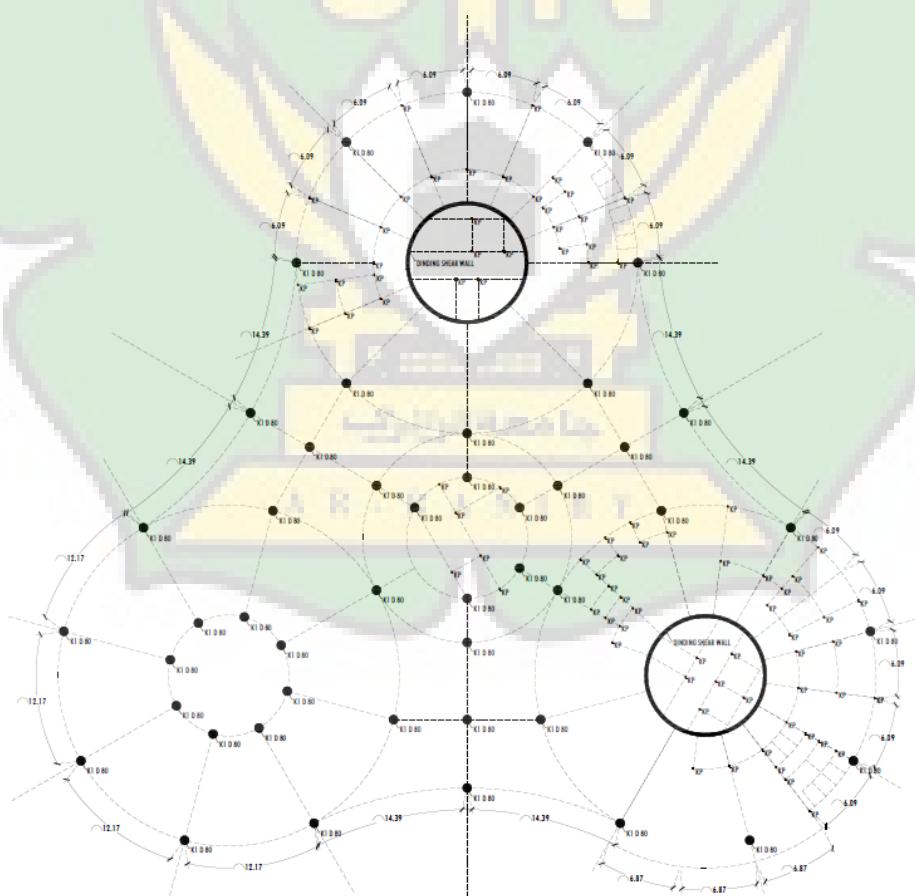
Denah Rencana Balok Lantai 4
